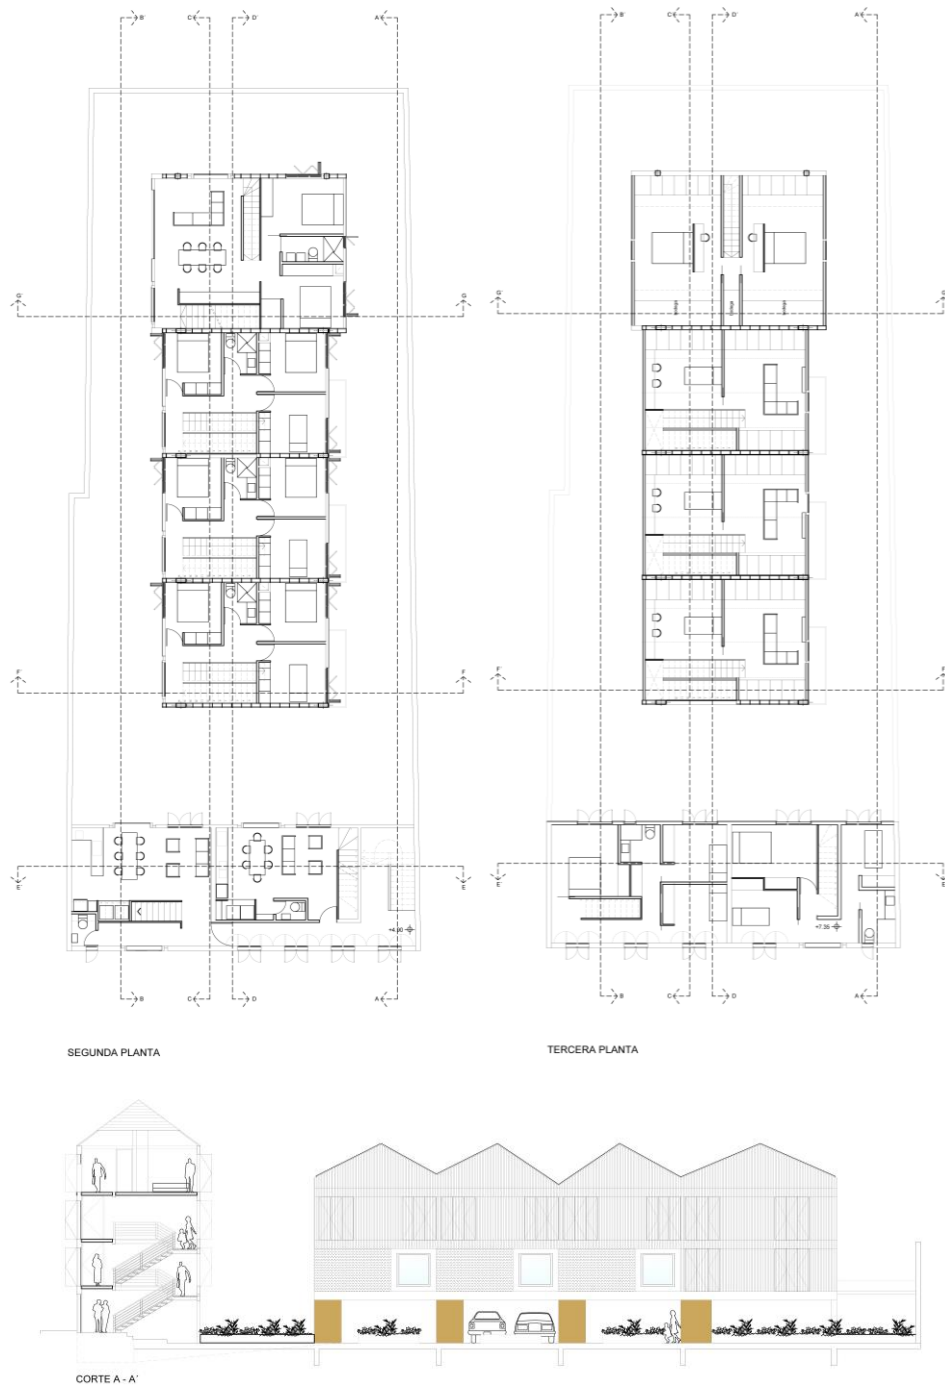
Plantas y corte del proyecto de obra nueva. Fuente: cortesía de Yes Innovation
